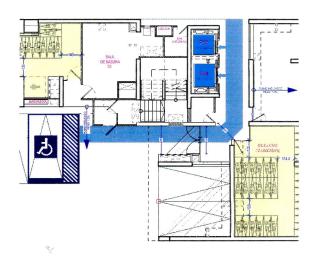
acceso oriente desde estacionamiento con ruta accesible universal
